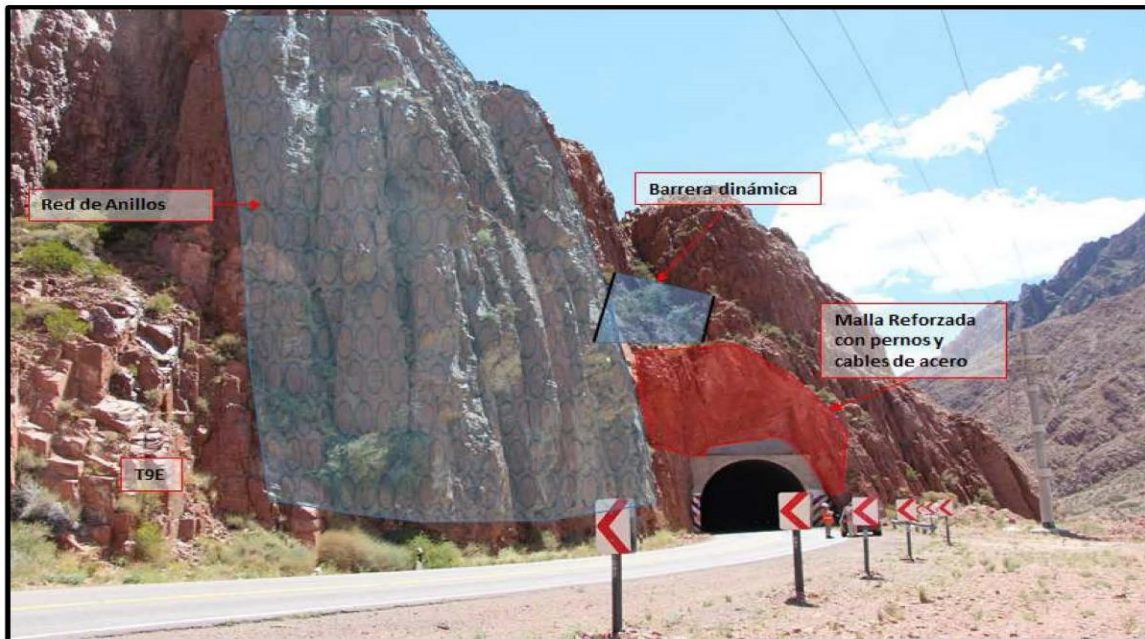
Vista general del esquema de protección propuesto para el portal entrada del túnel 9.
